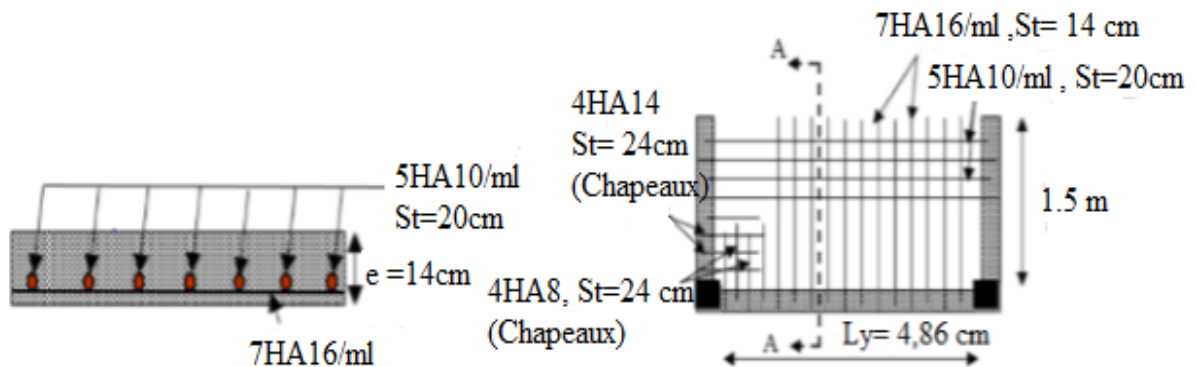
Schéma de ferrailage de la dalle sur 3 appuis (balcon étage courant)
